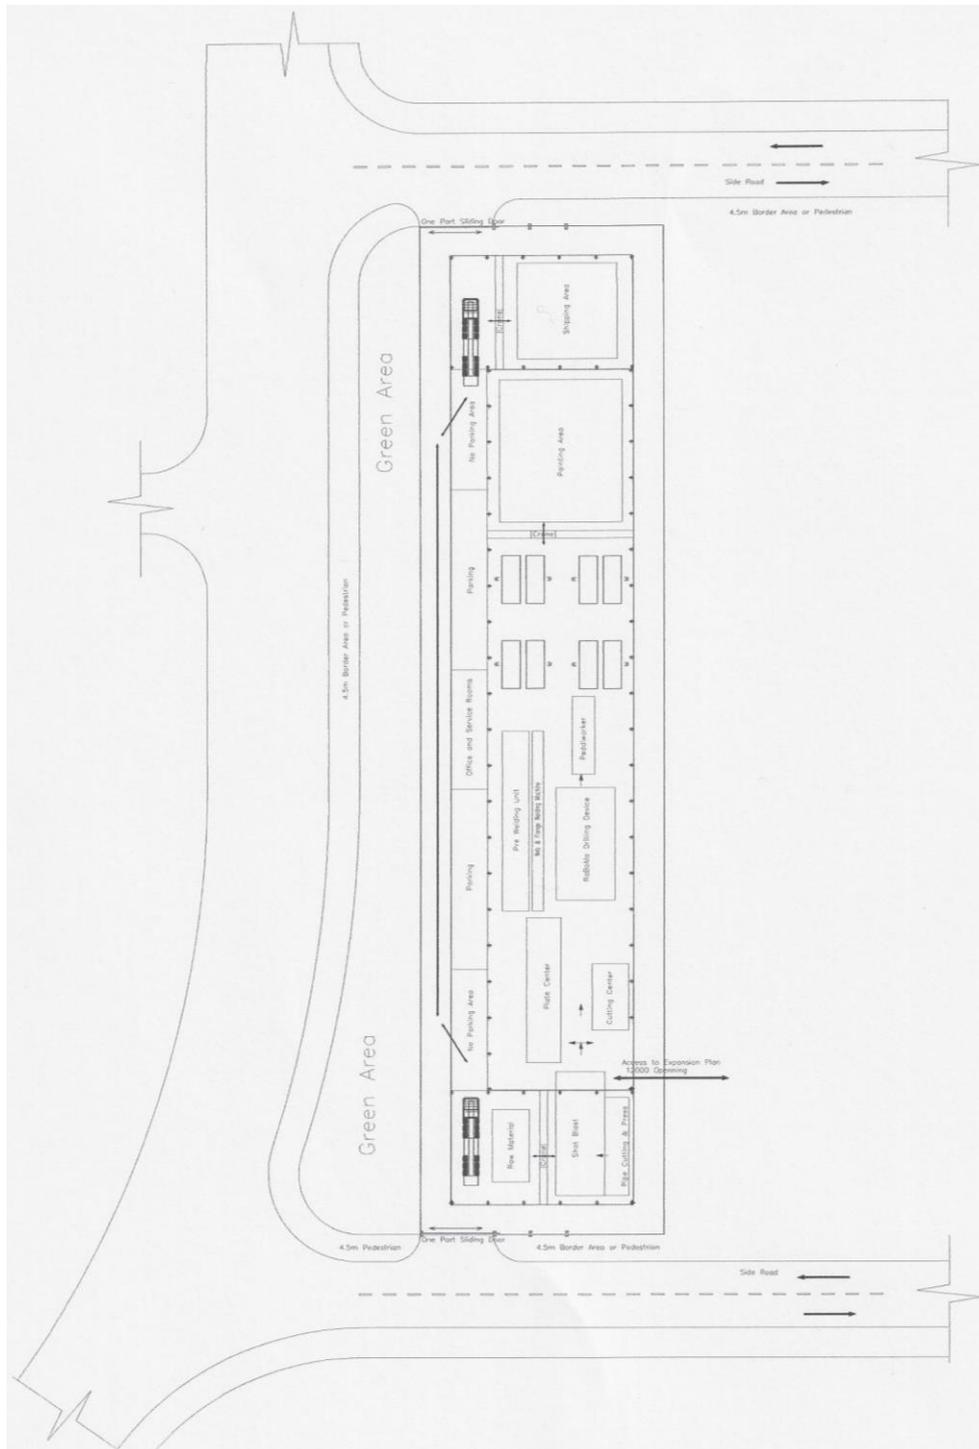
Werkslayout für ein Stahlbauwerk im Entwicklungsland
